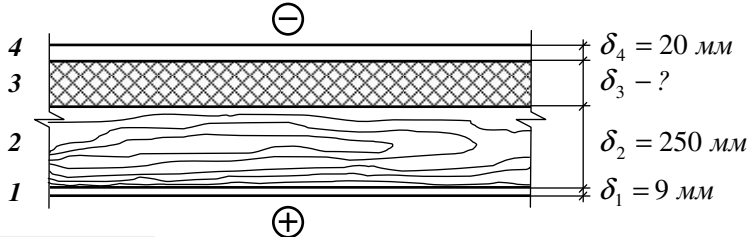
Розрахункова схема конструкції горищного перекриття (переріз 1-1)
